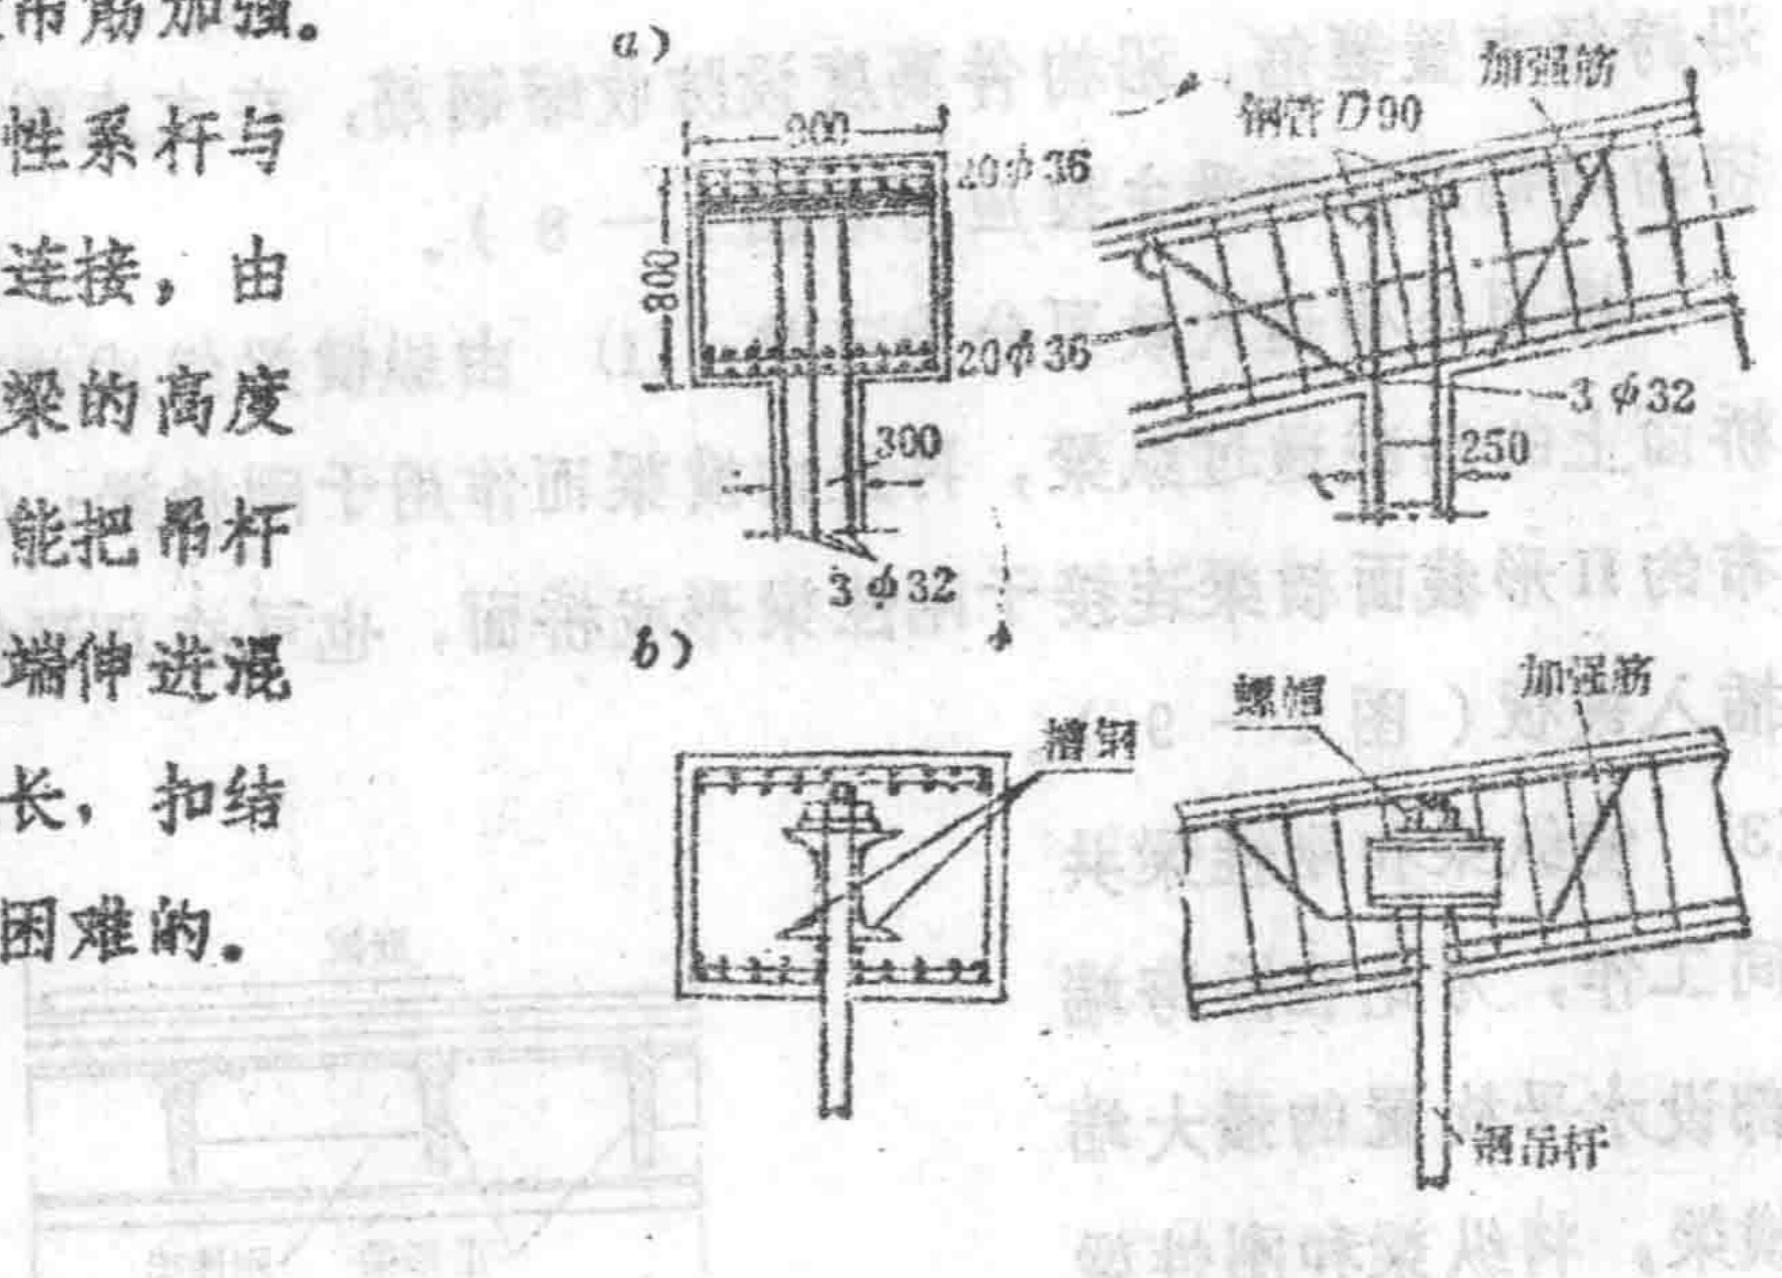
7 吊杆与拱肋的连接(尺寸单位: mm)
